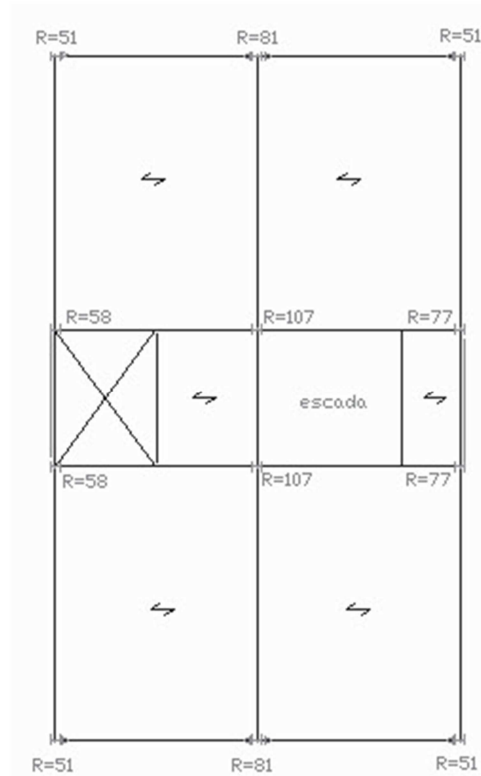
10 – Cargas nas vigas do pavimento tipo
